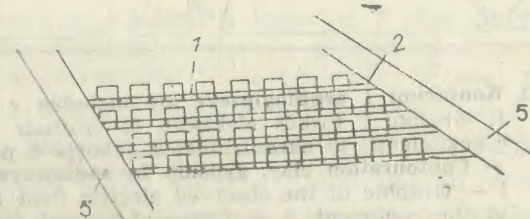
Planimetria e nivelit të shfrytëzimit.
